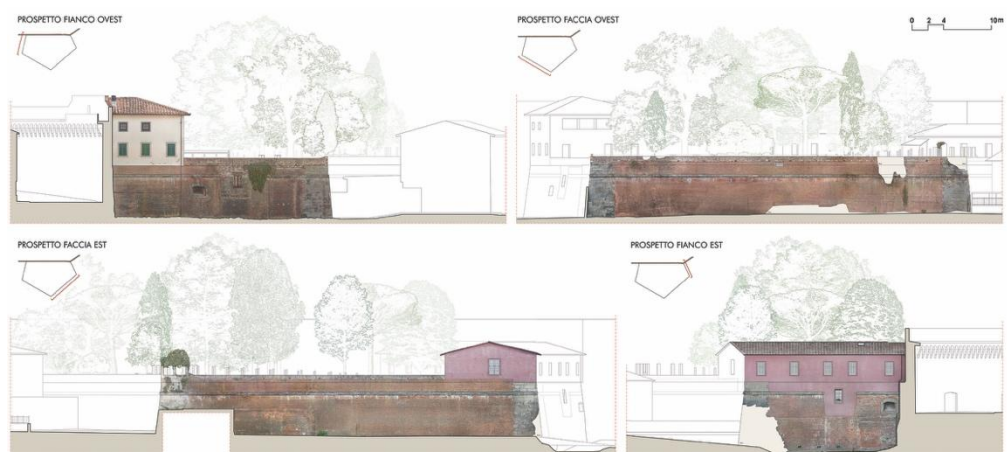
Prospetti dei fianchi e delle facce del bastione (Guarducci Paula)
